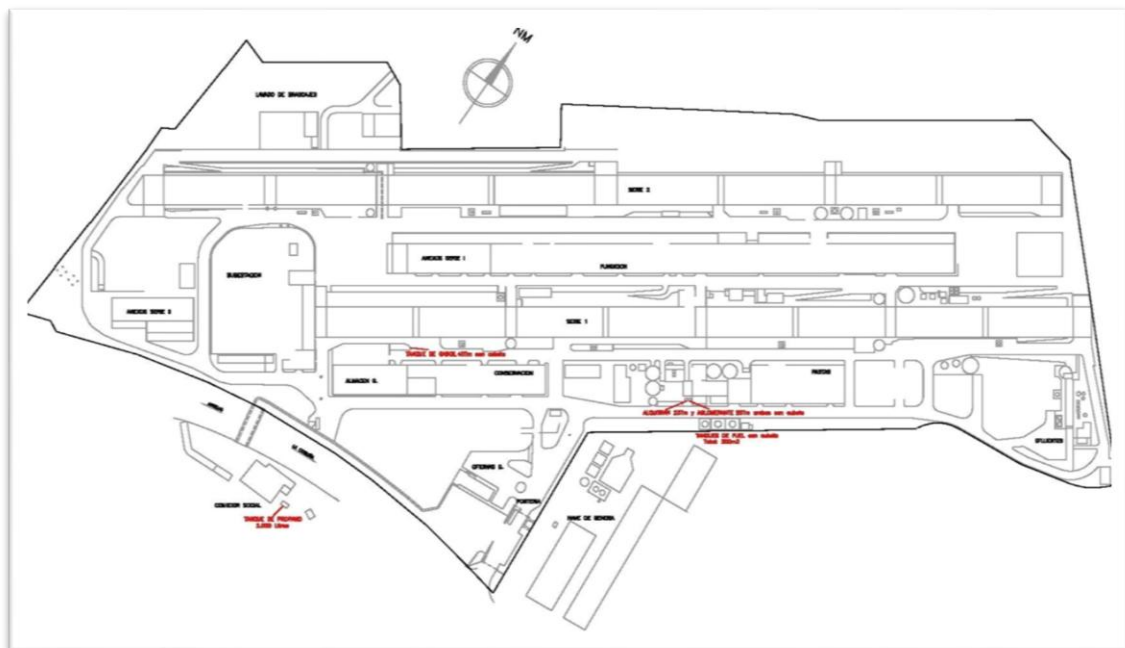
Plano Instalacións Alcoa Inespal, S.A.
